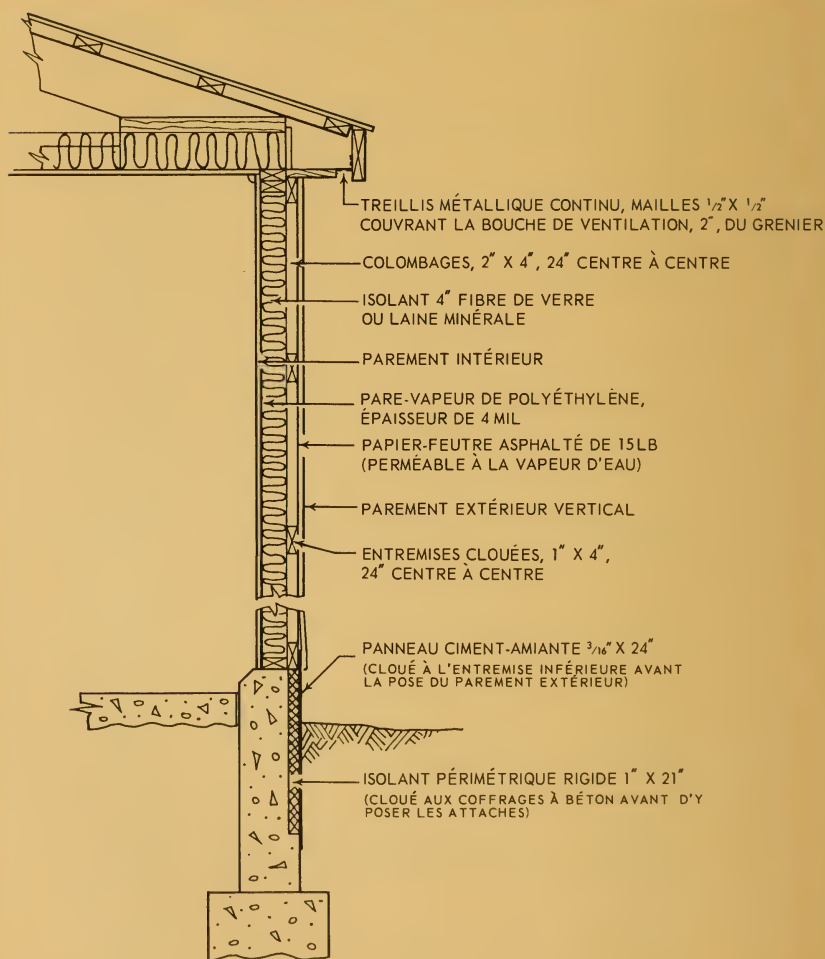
Coupe d'un mur isolé typique pour bâtiment de ferme.
